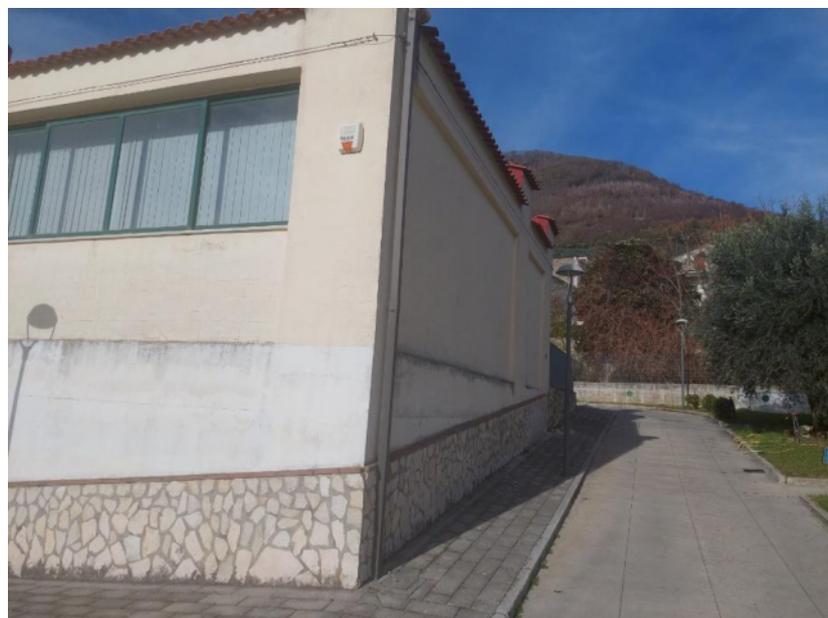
vista rampa di ingresso prospetto Est Istituto F.Filzi
